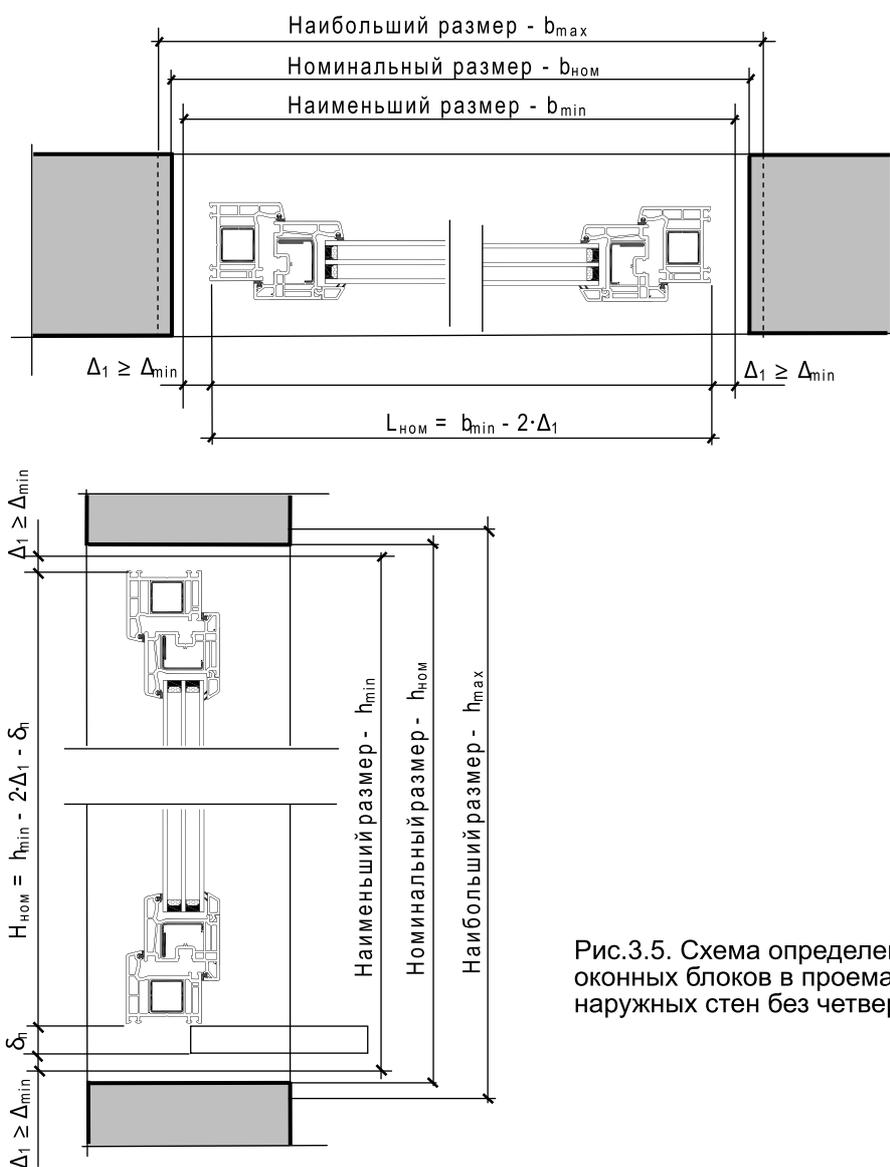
Схема определения размеров оконных блоков в проемах наружных стен без четвертей
